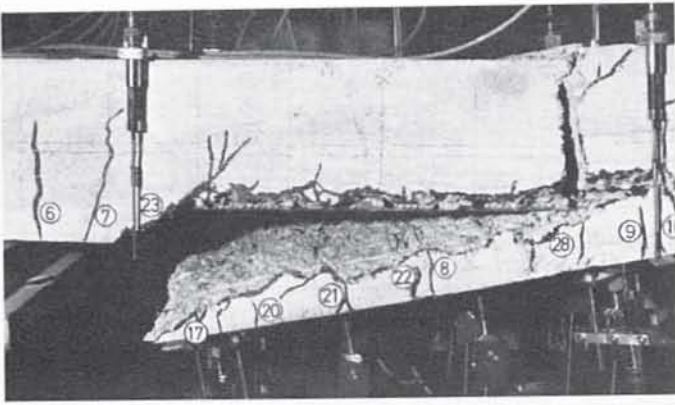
Bruchbild eines Balkens mit Dübelbefestigungen im Bereich des Bewehrungsstoßes [16]
